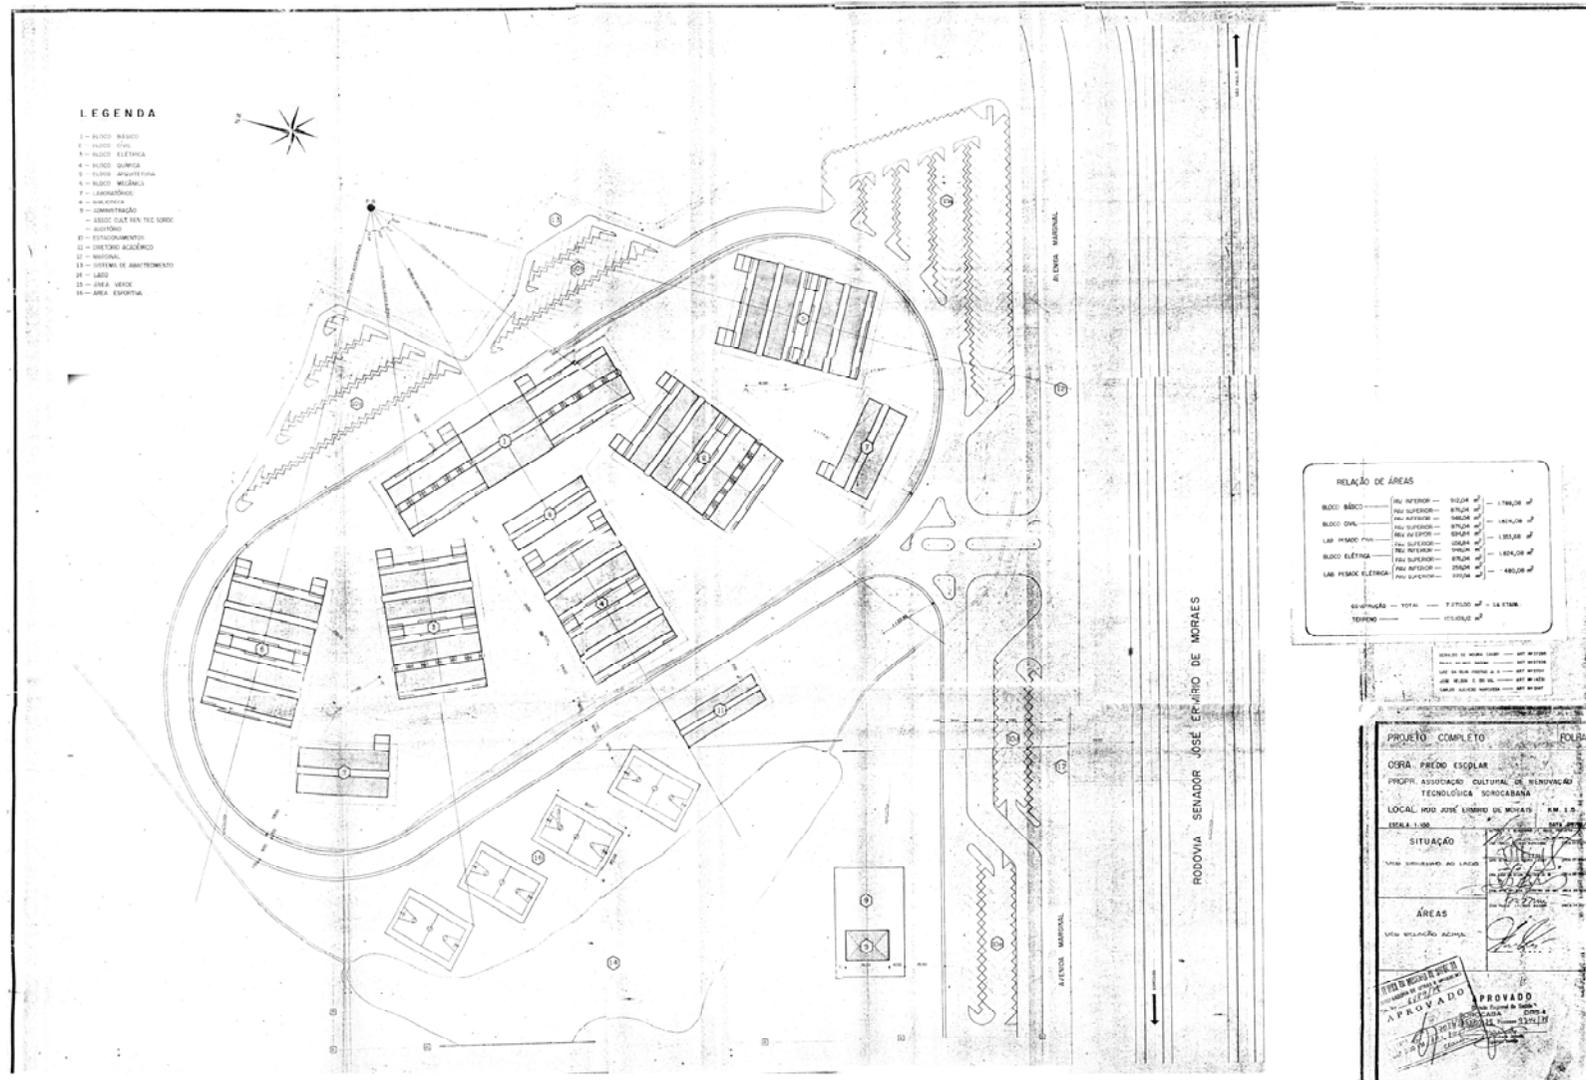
Projeto Geral de Construção da FACENS. (Fonte: Arquivo FACENS).
